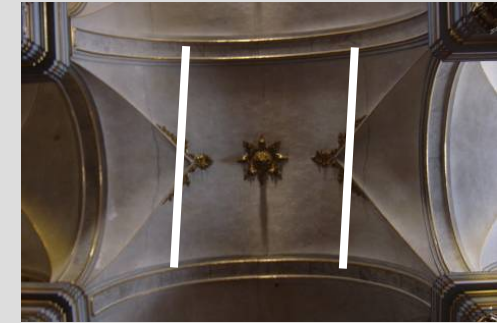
Fisuras a 1/3 (Año 2005)
